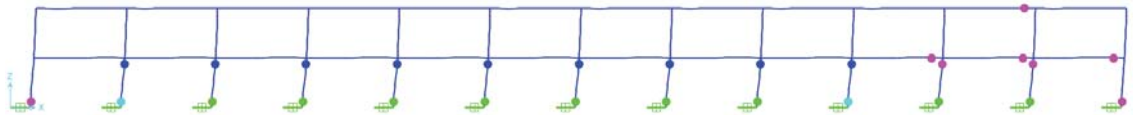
Secciones de columna en estado de Prevención del Colapso – Aislado
